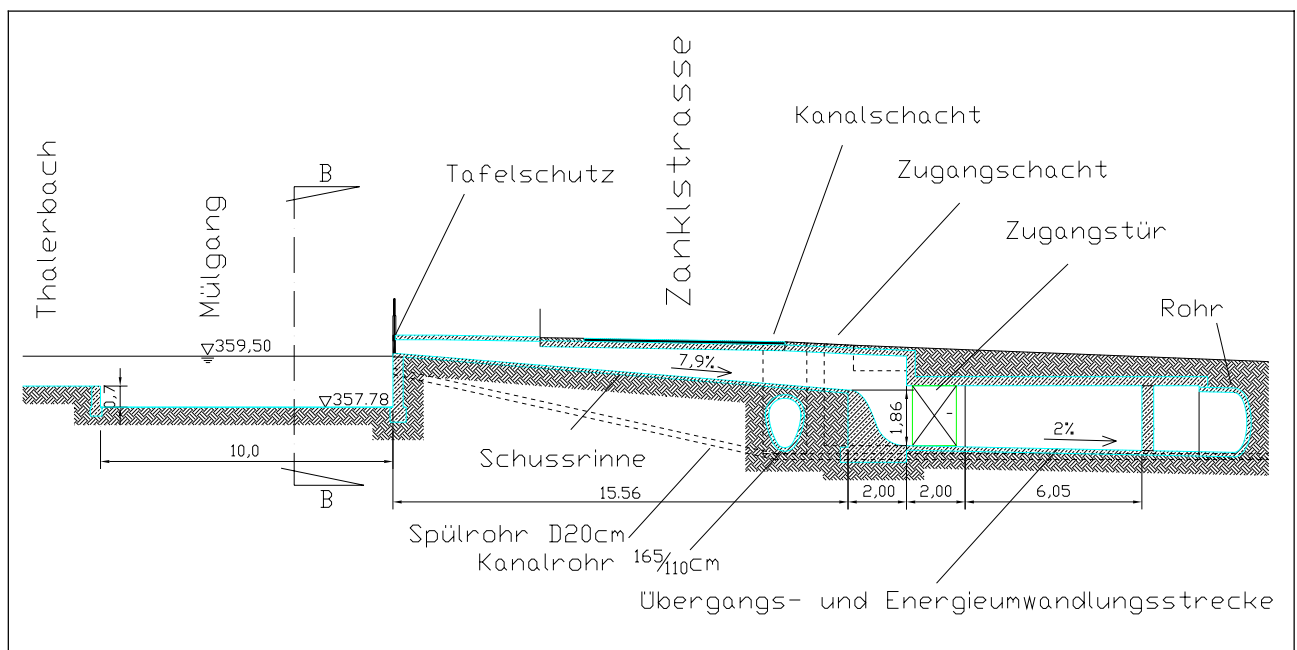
Einlaufbauwerk, Schnitt A-A, Variante 3
